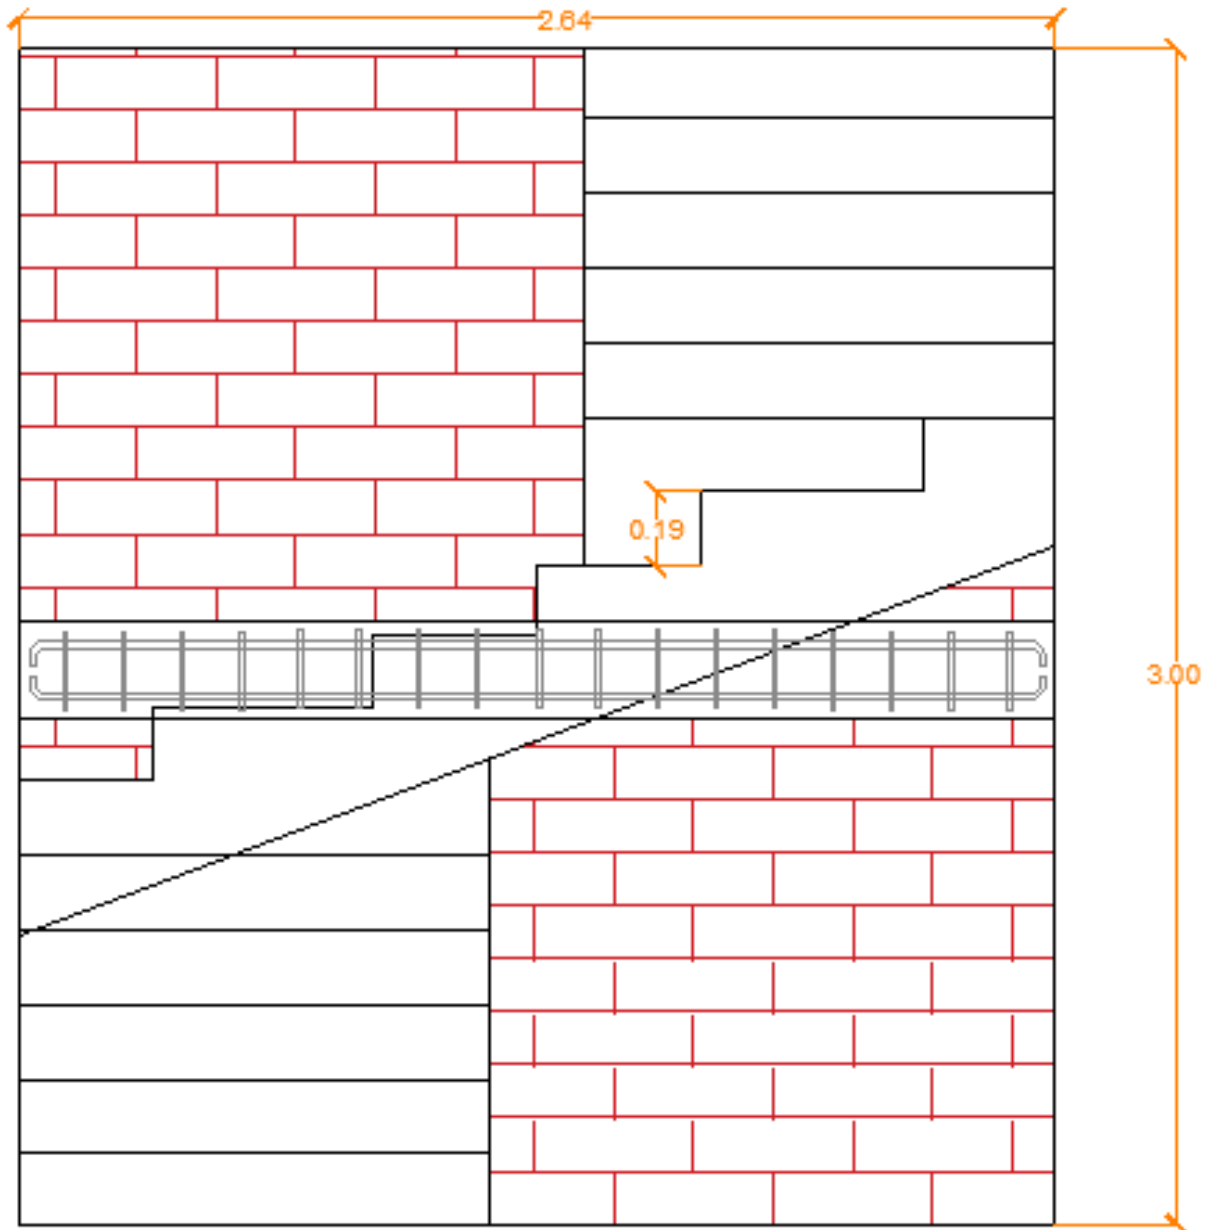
Vista en Perfil de las Escaleras Transversales. Fuente: Nicolás Pozo
